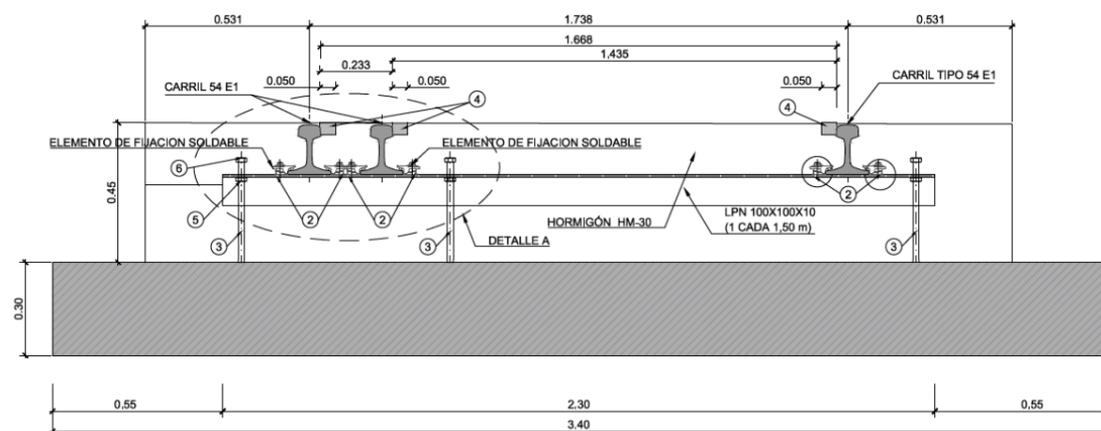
Montaje perfil metálico para vía estuchada ancho mixto
